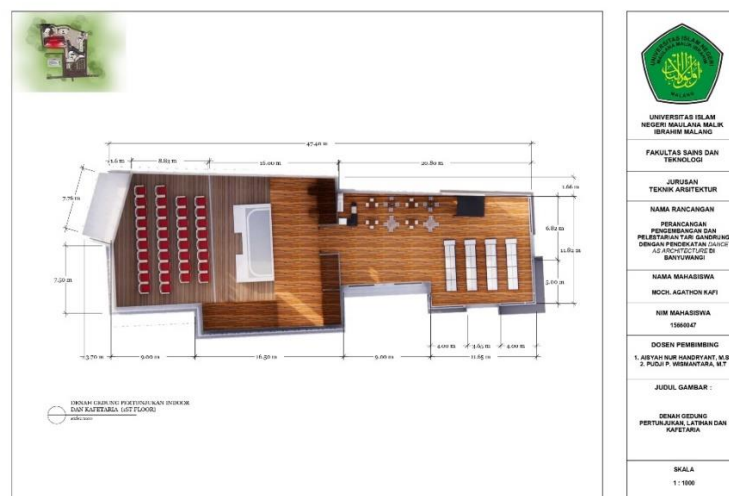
Denah Gedung 1 Lt 1 dan 2
